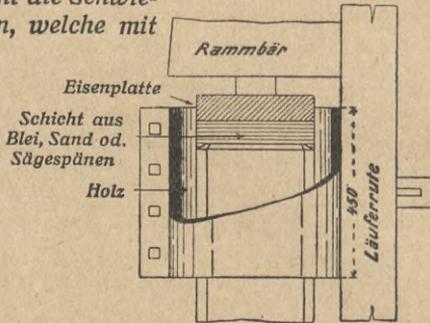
Schlaghaube für Eisenbetonpfähle.
